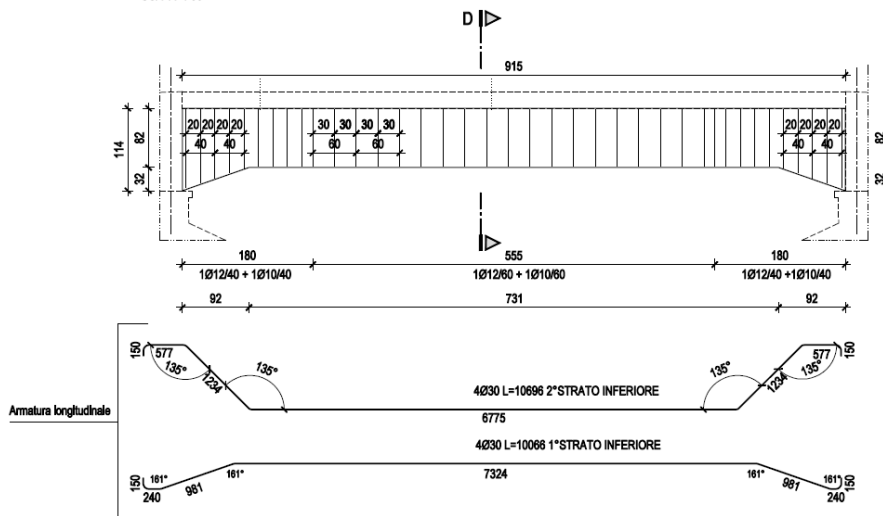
Rilievo geometrico dell'impalcato - Sezione longitudinale ed indicazioni delle armature rilevate
